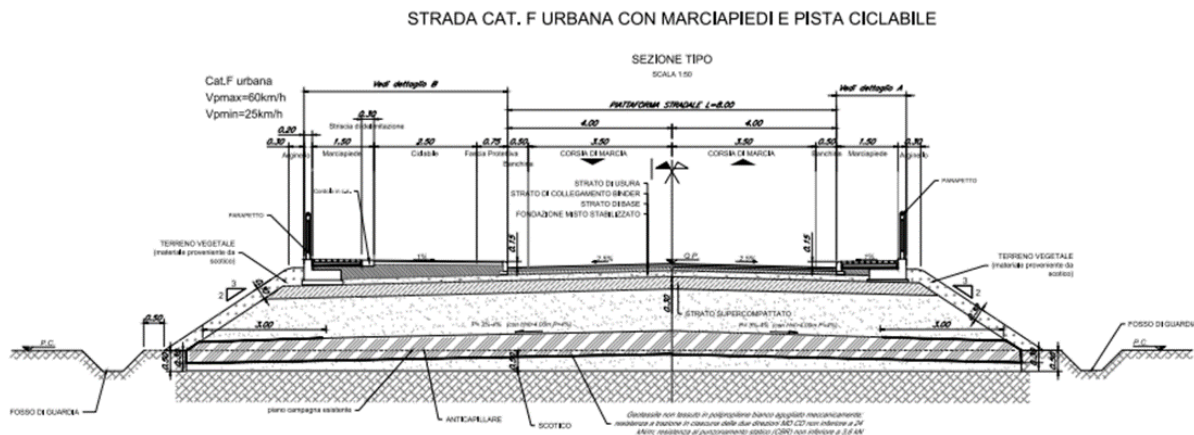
Sezione tipo della viabilità di accesso alla fermata (NV01A)
